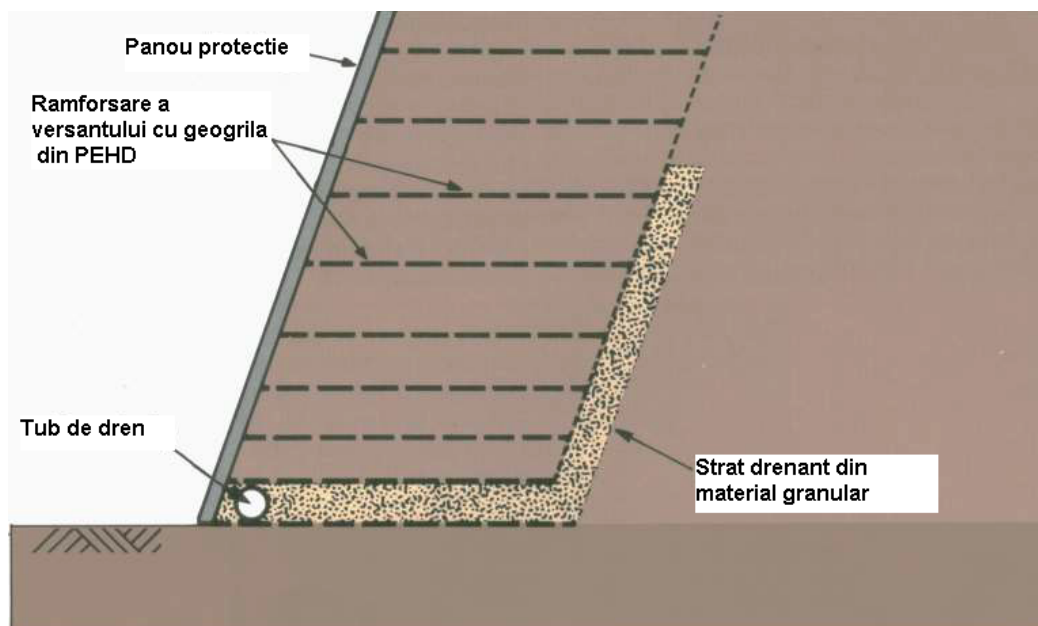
Consolidare cu panou de protecție și ancoraj din geotextil
